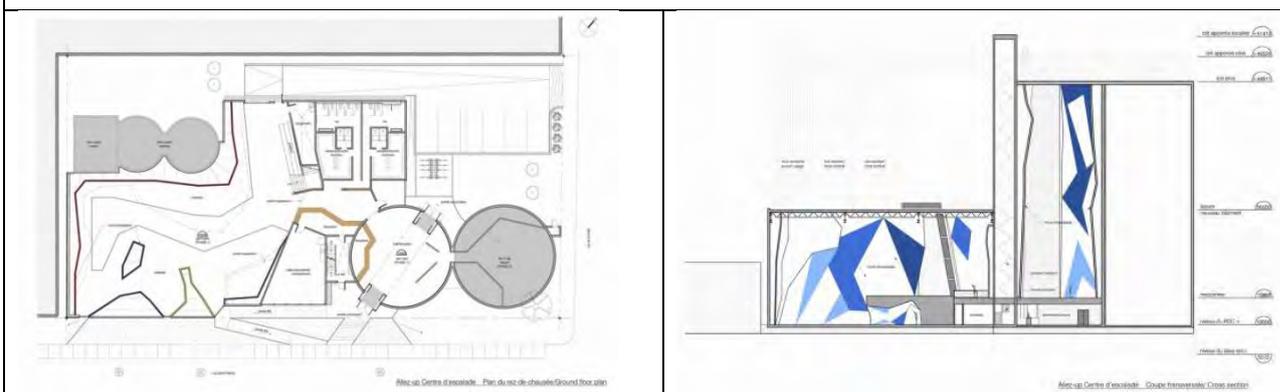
“ Allez-Up ”. Генплан и разрез.
